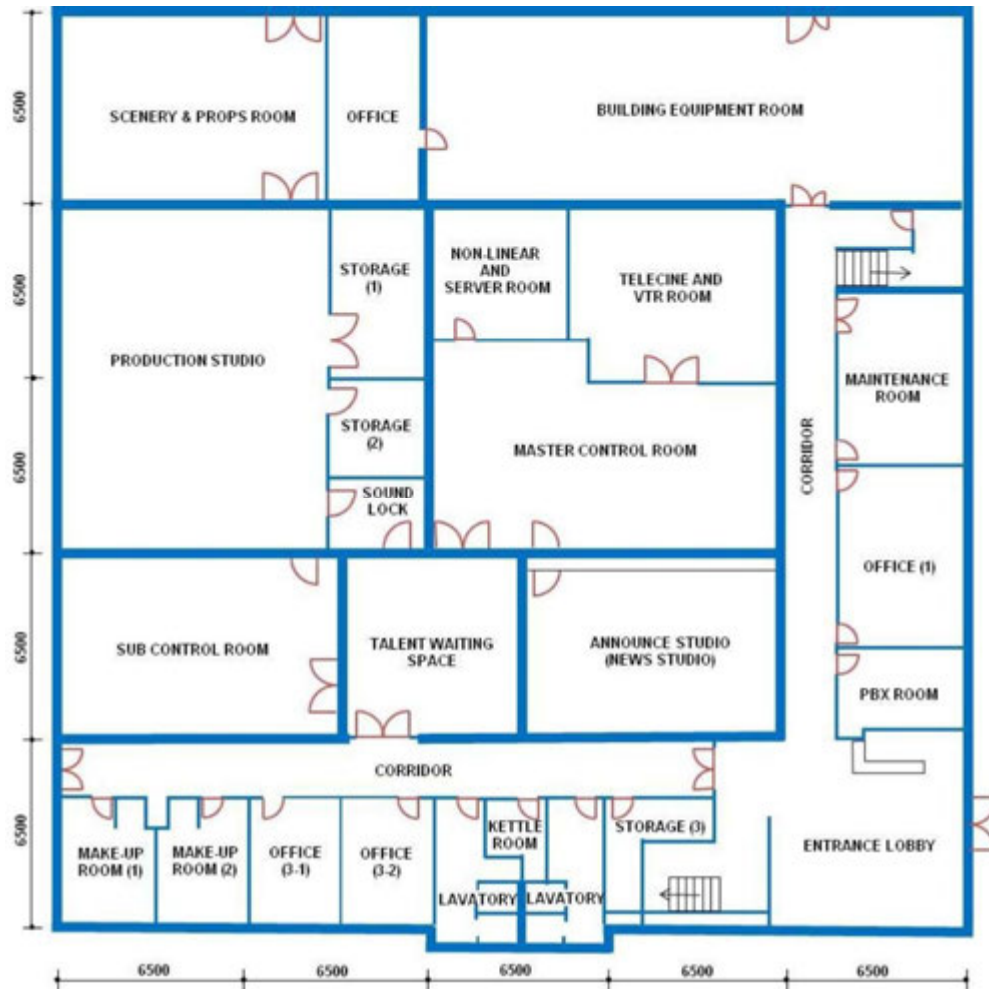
カブール・テレビ放送局 1 階平面図
